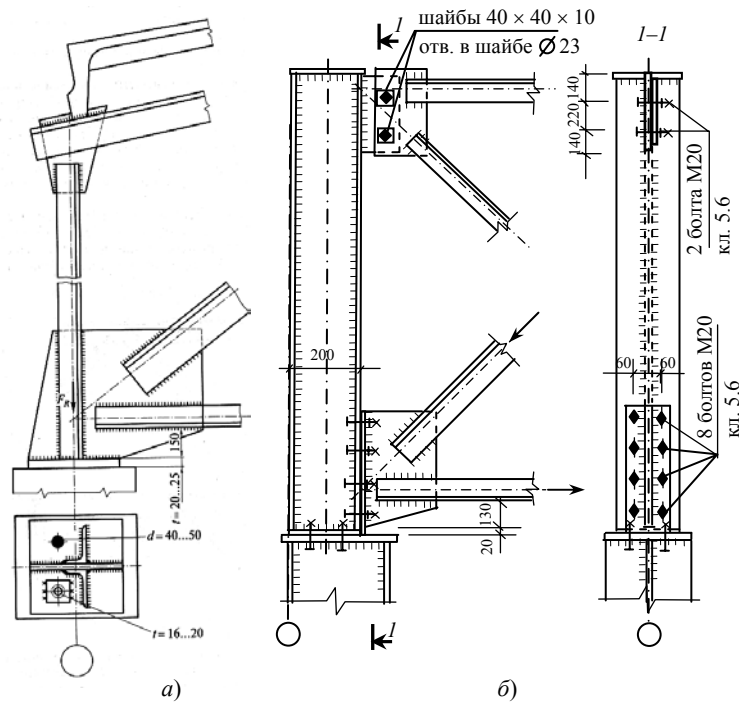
Узлы опирания стропильной фермы из парных уголков на колонны:
